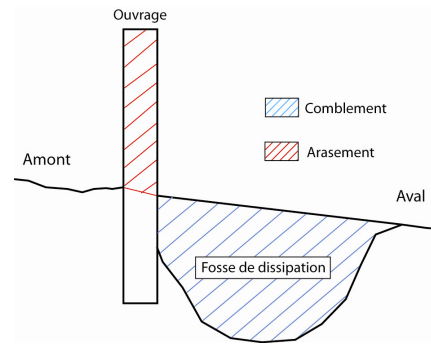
Coupe en travers d'une intervention sur ouvrage.
